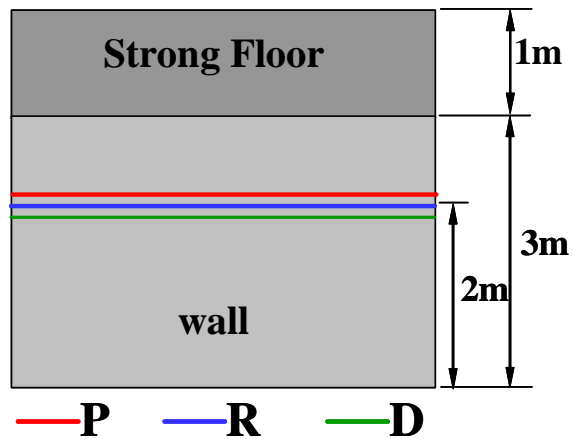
地下室硬管配置圖 (沿 wall 方向)
